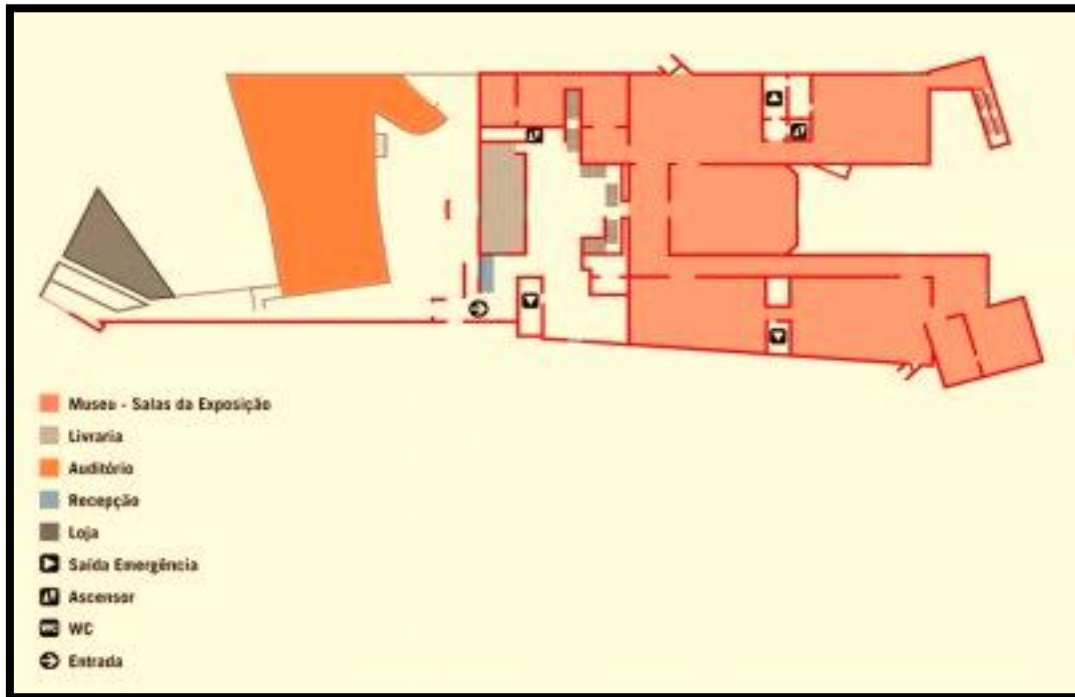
Planta do primeiro pavimento do Museu da fundação Serralves, dispõe das diversas tipografias expositivas, hachuras em rosa são as diversas salas de exposição e salas de múltiplo uso, elemento este de suma importância nesta tipologia de espaços contemporâneos.
